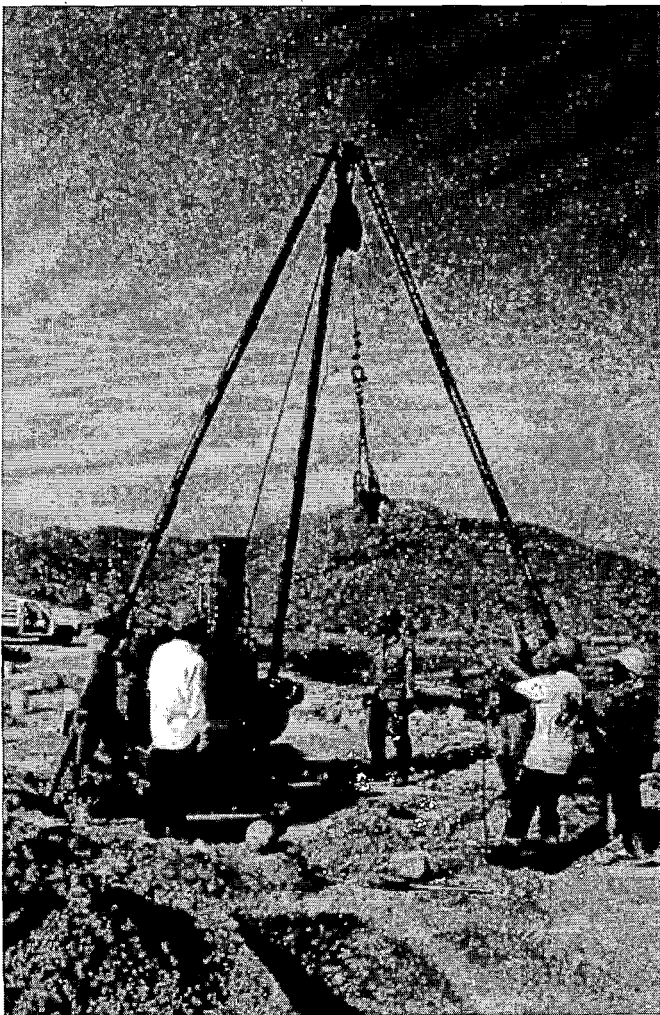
Equipo utilizado en la Presa Tinajones y generación de ondas S.
